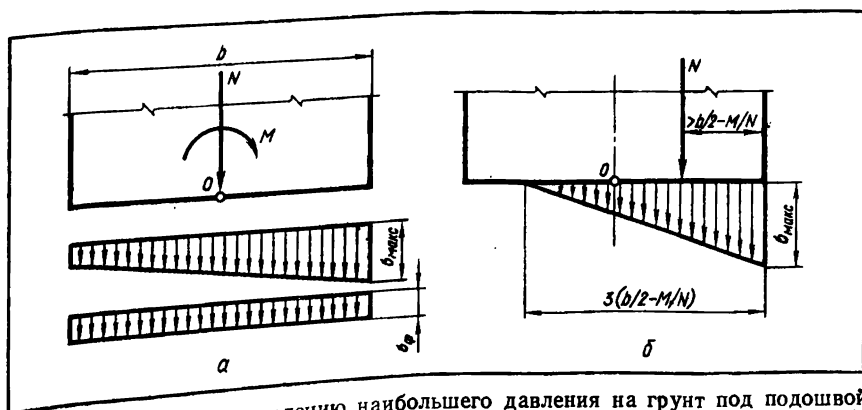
Схемы к определению наибольшего давления на грунт под подошвой фундамента $F = ab$:
